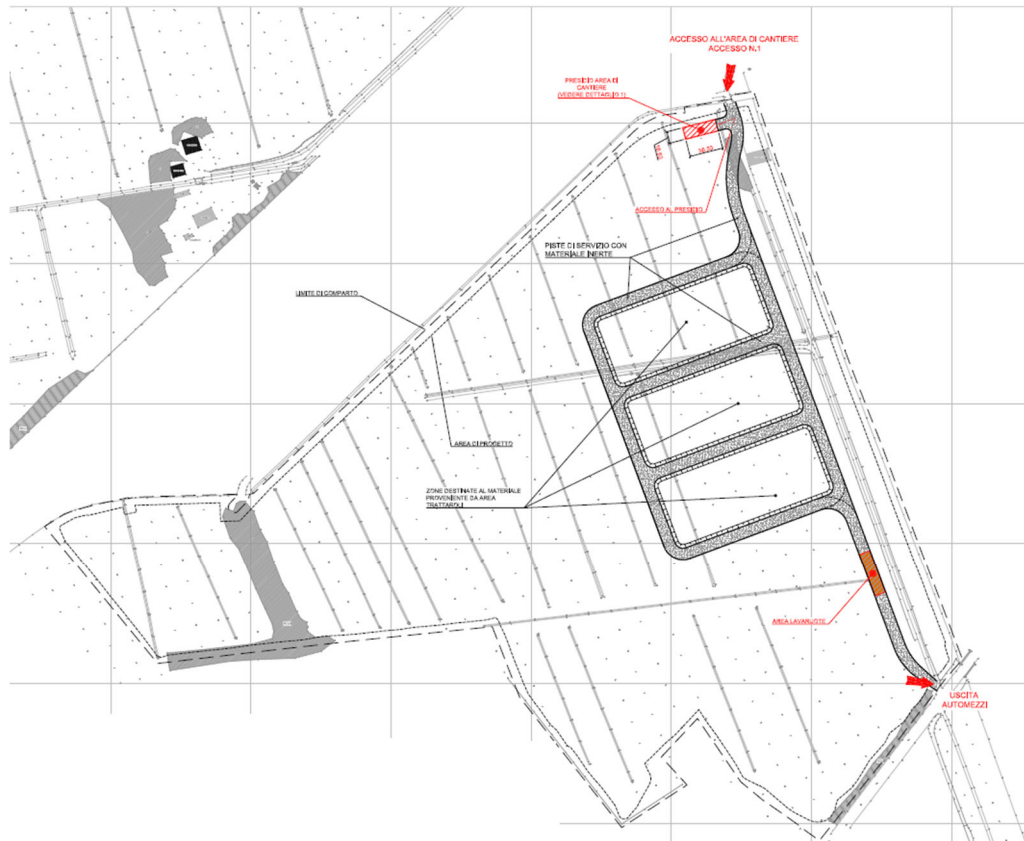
Planimetria dell'area di cantiere del comparto S3 sud
